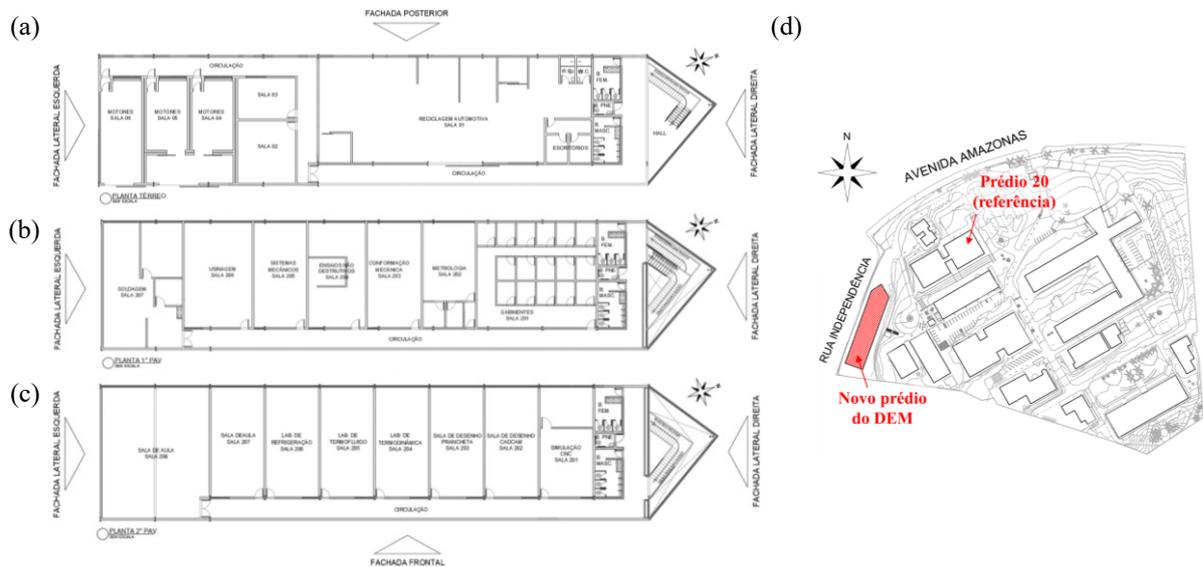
Plantas do prédio a ser construído no Campus NG: (a) pavimento térreo, (b) 1º pavimento; (c) 2º pavimento; e (d) implantação. Fonte: Adaptado de Divisão de Projetos do CEFET-MG.
